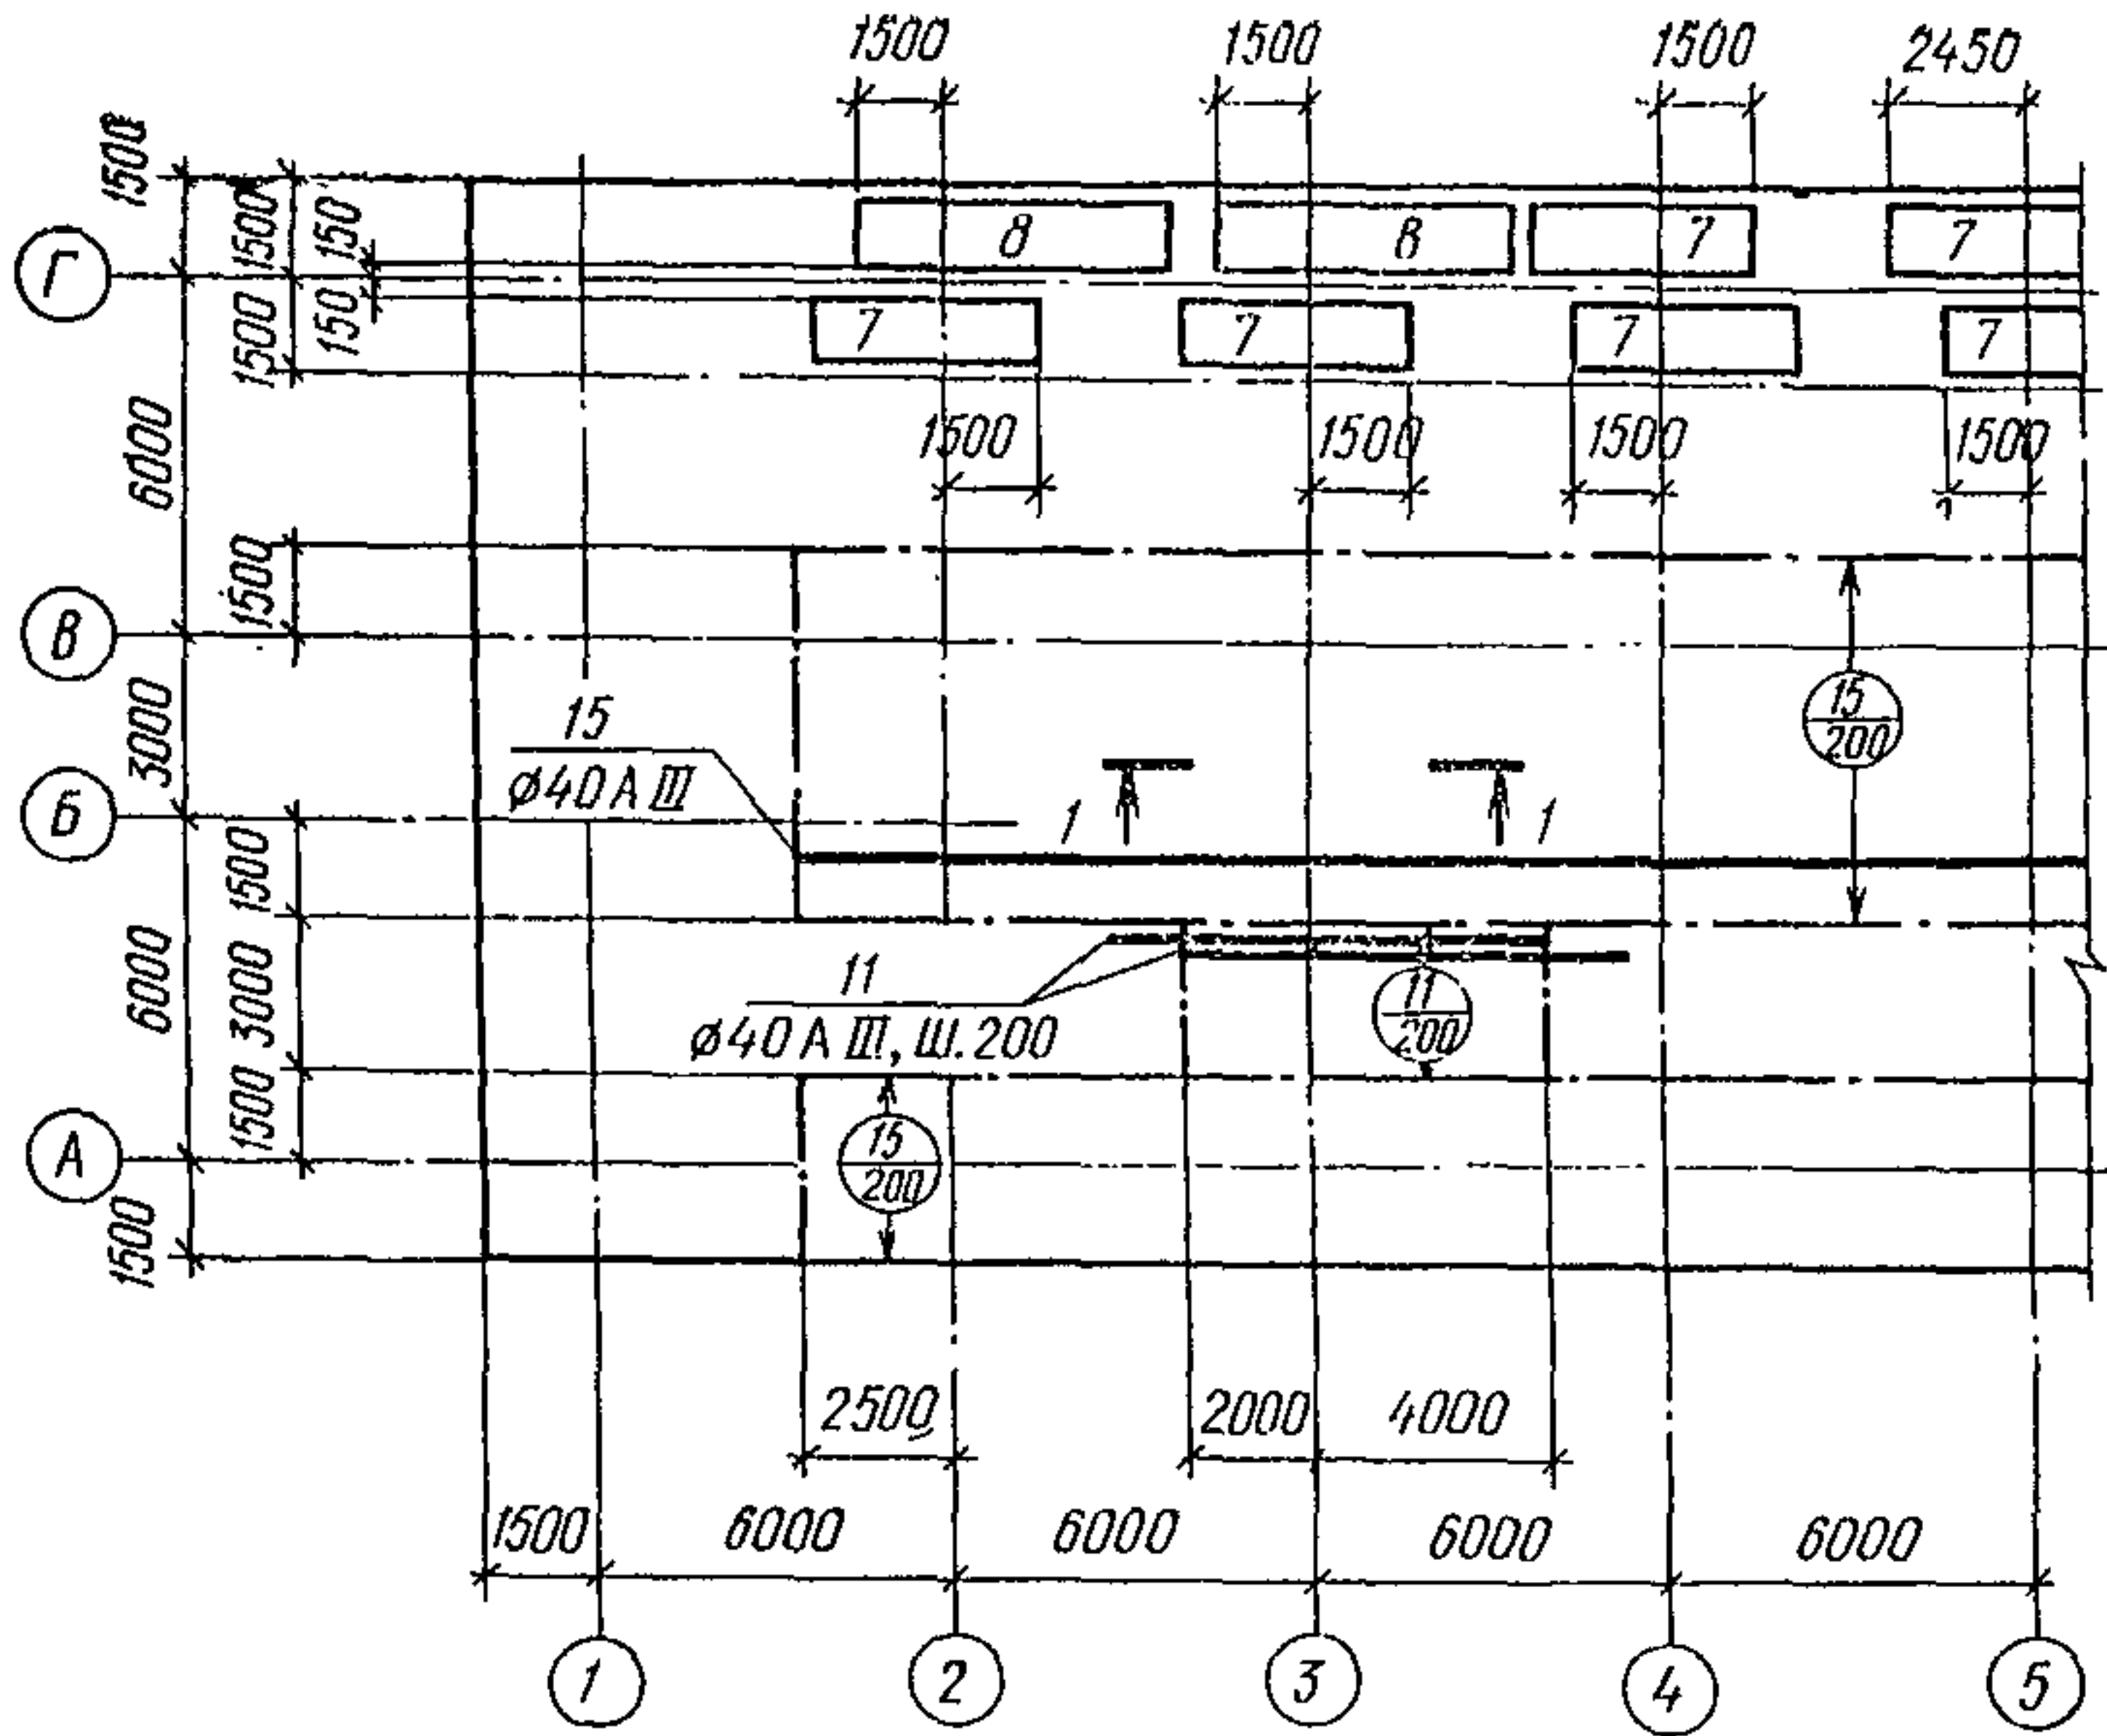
План раскладки унифицированных сеток и арматуры второго слоя нижней зоны (верхние сетки)
